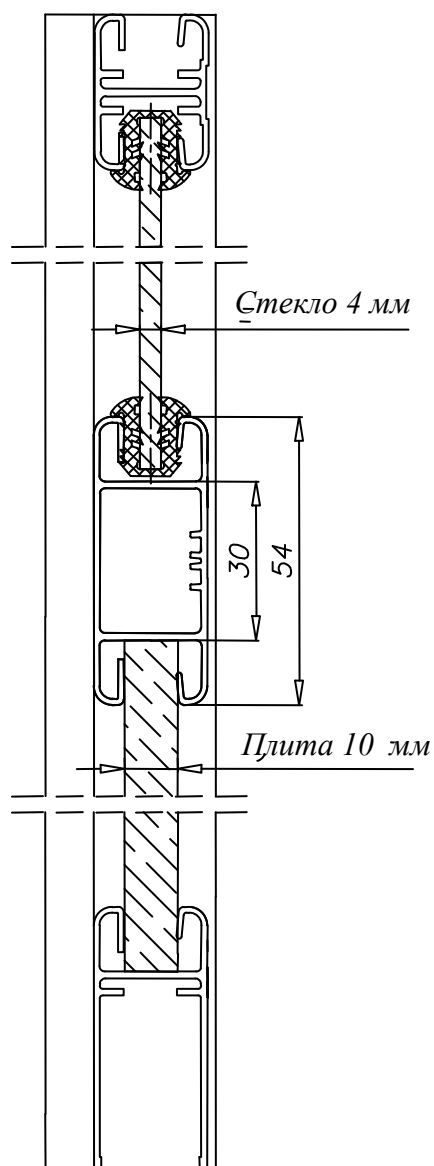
Раскрой дверей системы AL20 LAZURYT с делительным профилем для монтажа верхней блокировки на определенной высоте.
